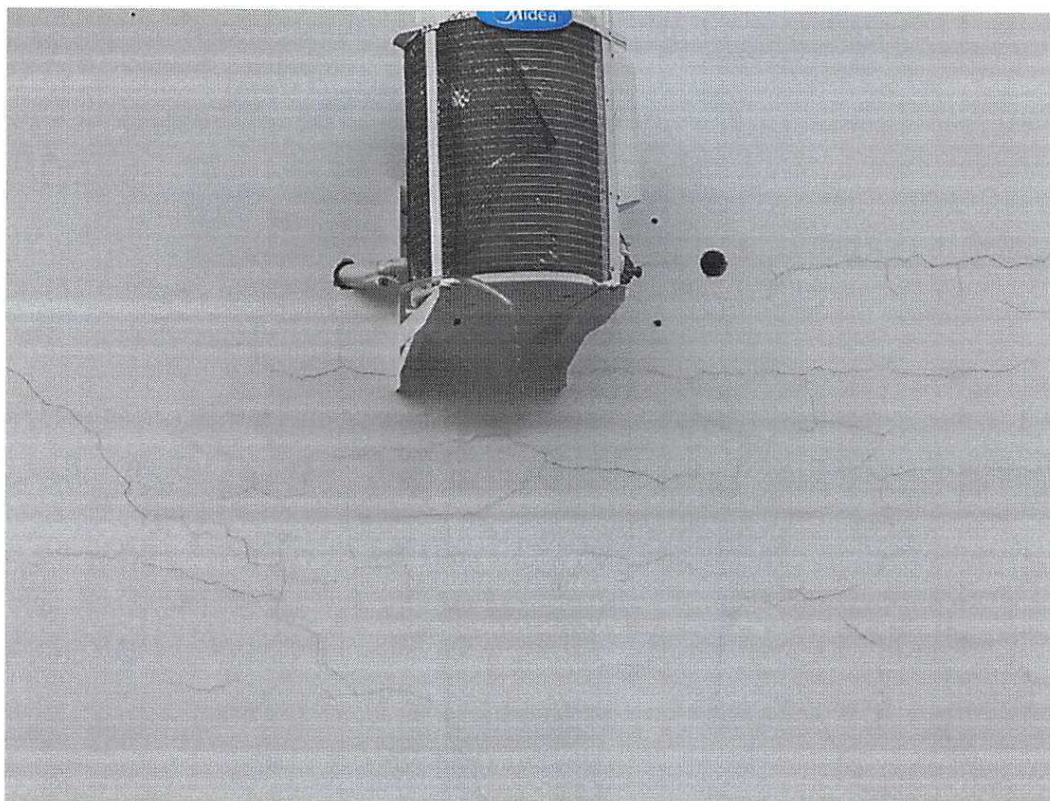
Trinca em parede em 45º considerada patologia grave.
